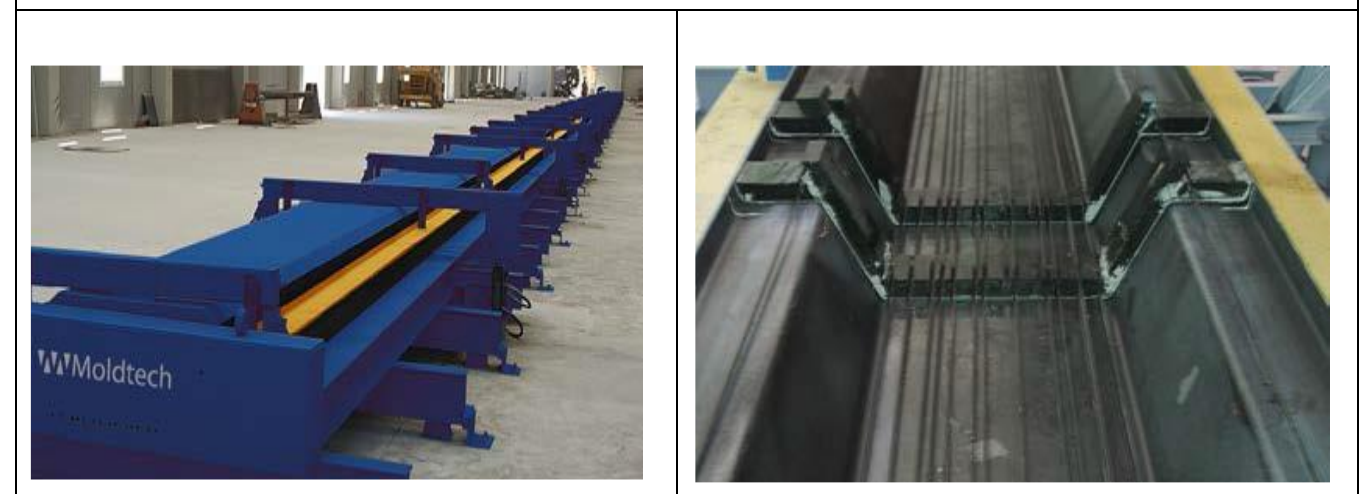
exemple Autres moules pour poutres armés et poutres maîtresses
